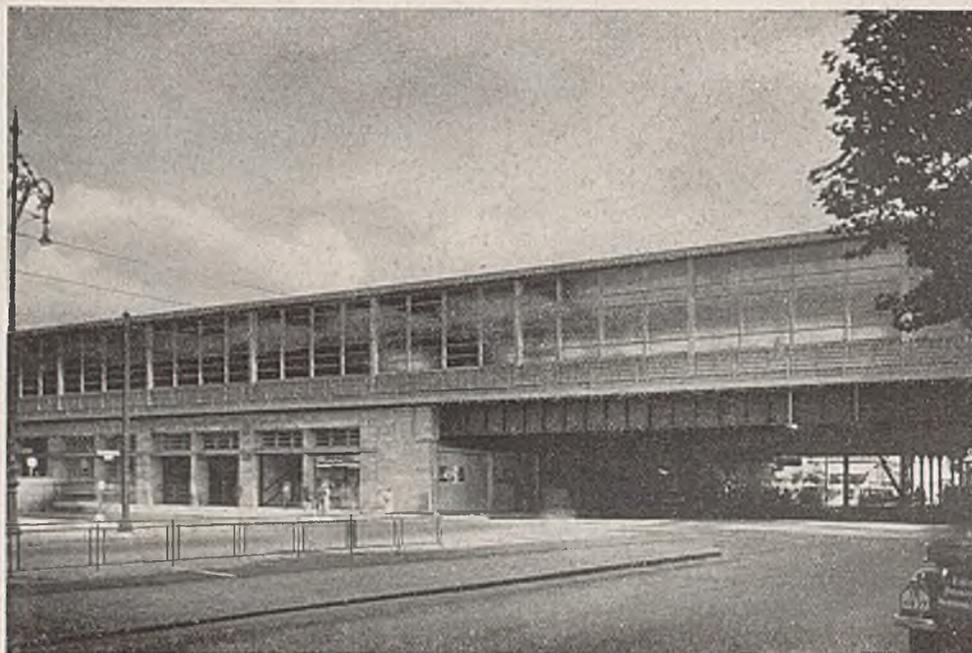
Unterführung der Hardenbergstraße in Berlin.
